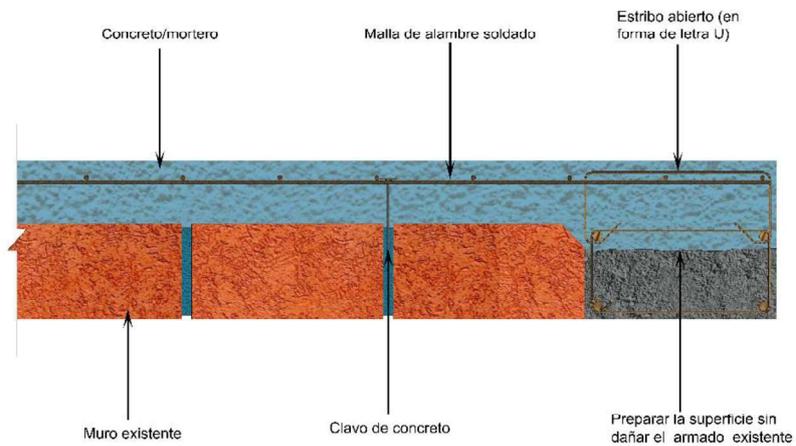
b – Detalle de la conexión del refuerzo del encamisado a castillos mediante estribos abiertos con dobleces a 135 grados (INIFED, 2021d)
